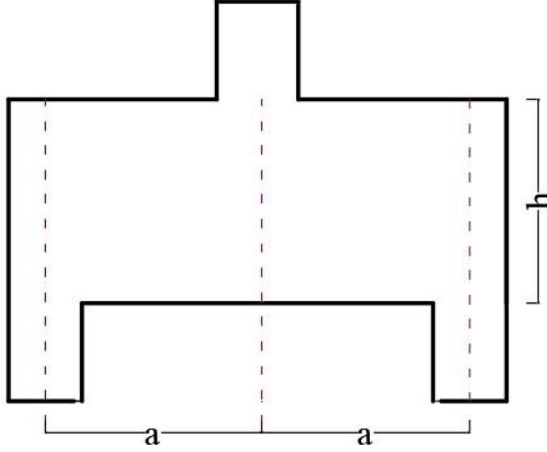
Köprülerde birden çok açıklıklı derin kiriş uygulaması (Al-Baijat ve Alhawamdeh, 2019).
